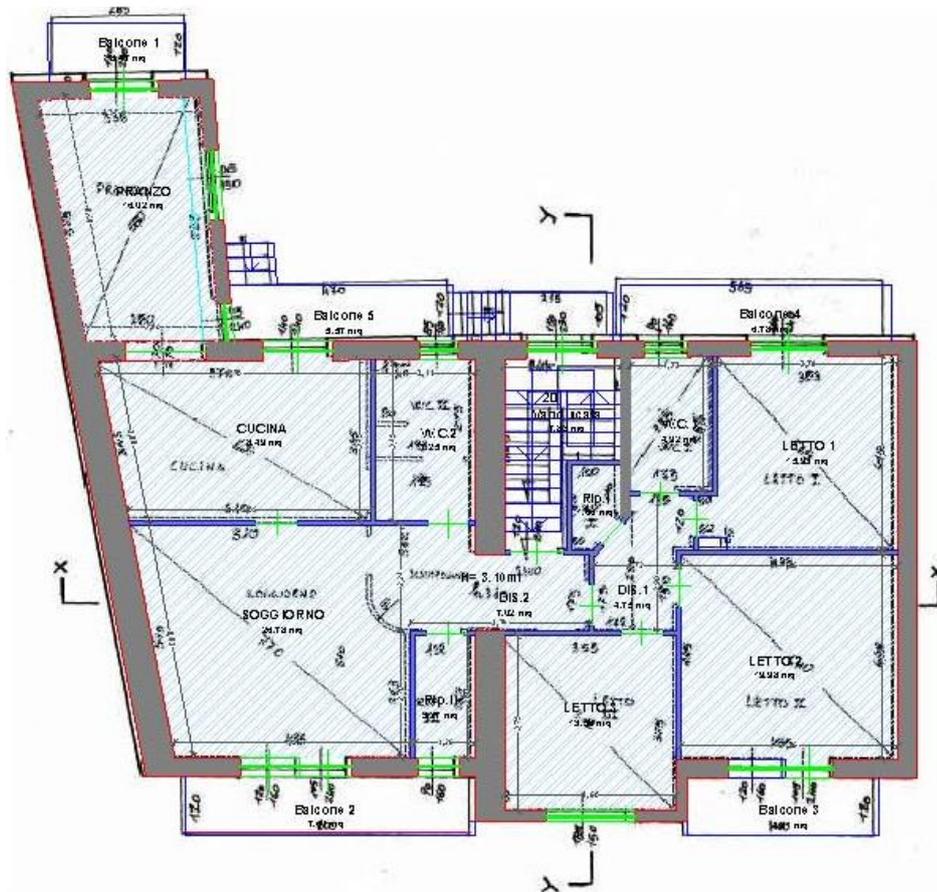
Sovrapposizione della Planimetria dello Stato reale dei luoghi con la Planimetria di Progetto.
